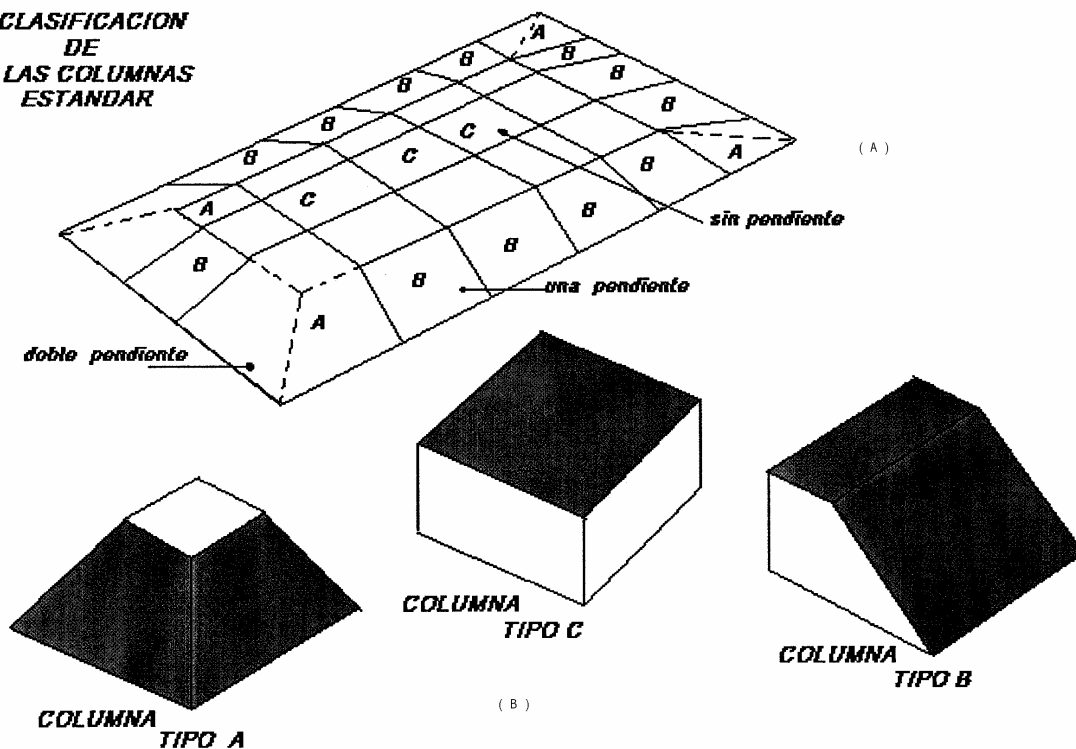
Columnas estándar. (A) Distribución. (B) Tipos.
